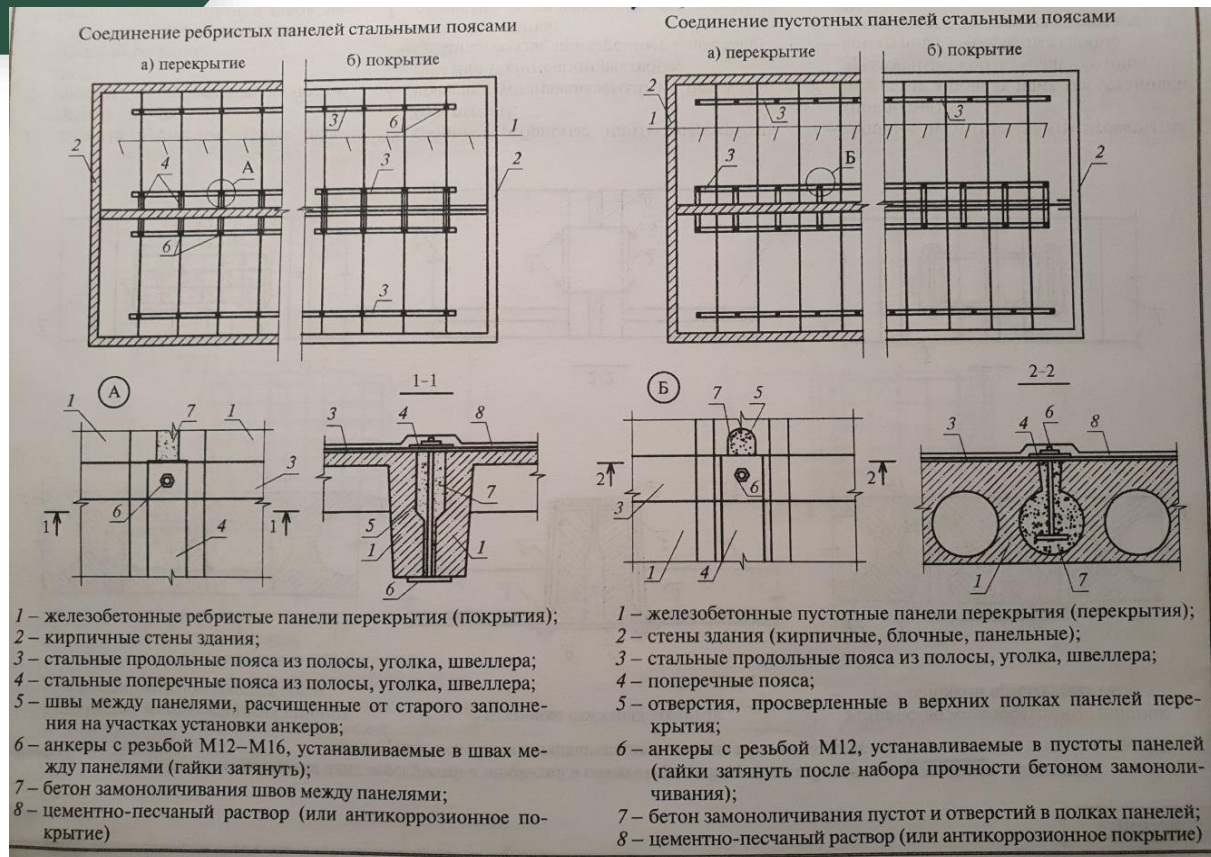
Схемы оценки работы ребристых перекрытий и покрытия здания
